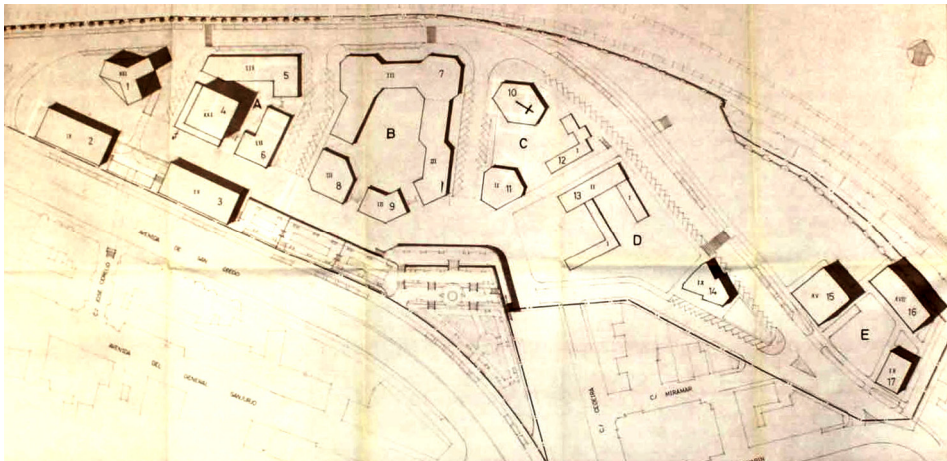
Plano General Plan Parcial San Diego. Fuente: Archivo General de Fomento.
